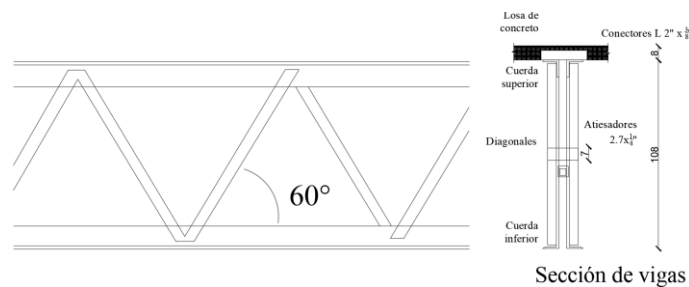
Viga metálica y losa de concreto. Características de los niveles N1 a Azotea (adaptado de SRE, 1963)
